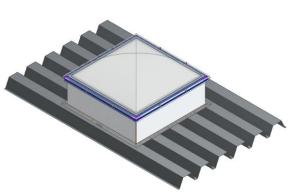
WiNa Stairvent avec rehausse de 360 mm directement sur bac acier (JID 137)
